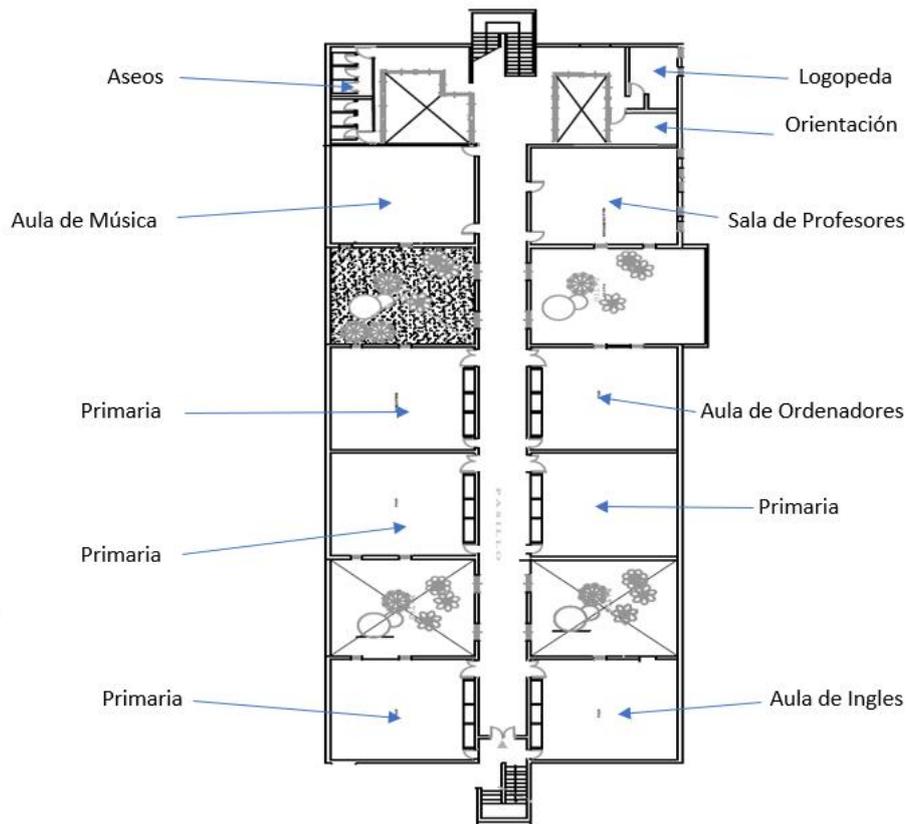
IMAGEN DEL CENTRO PLANTA ALTA.
